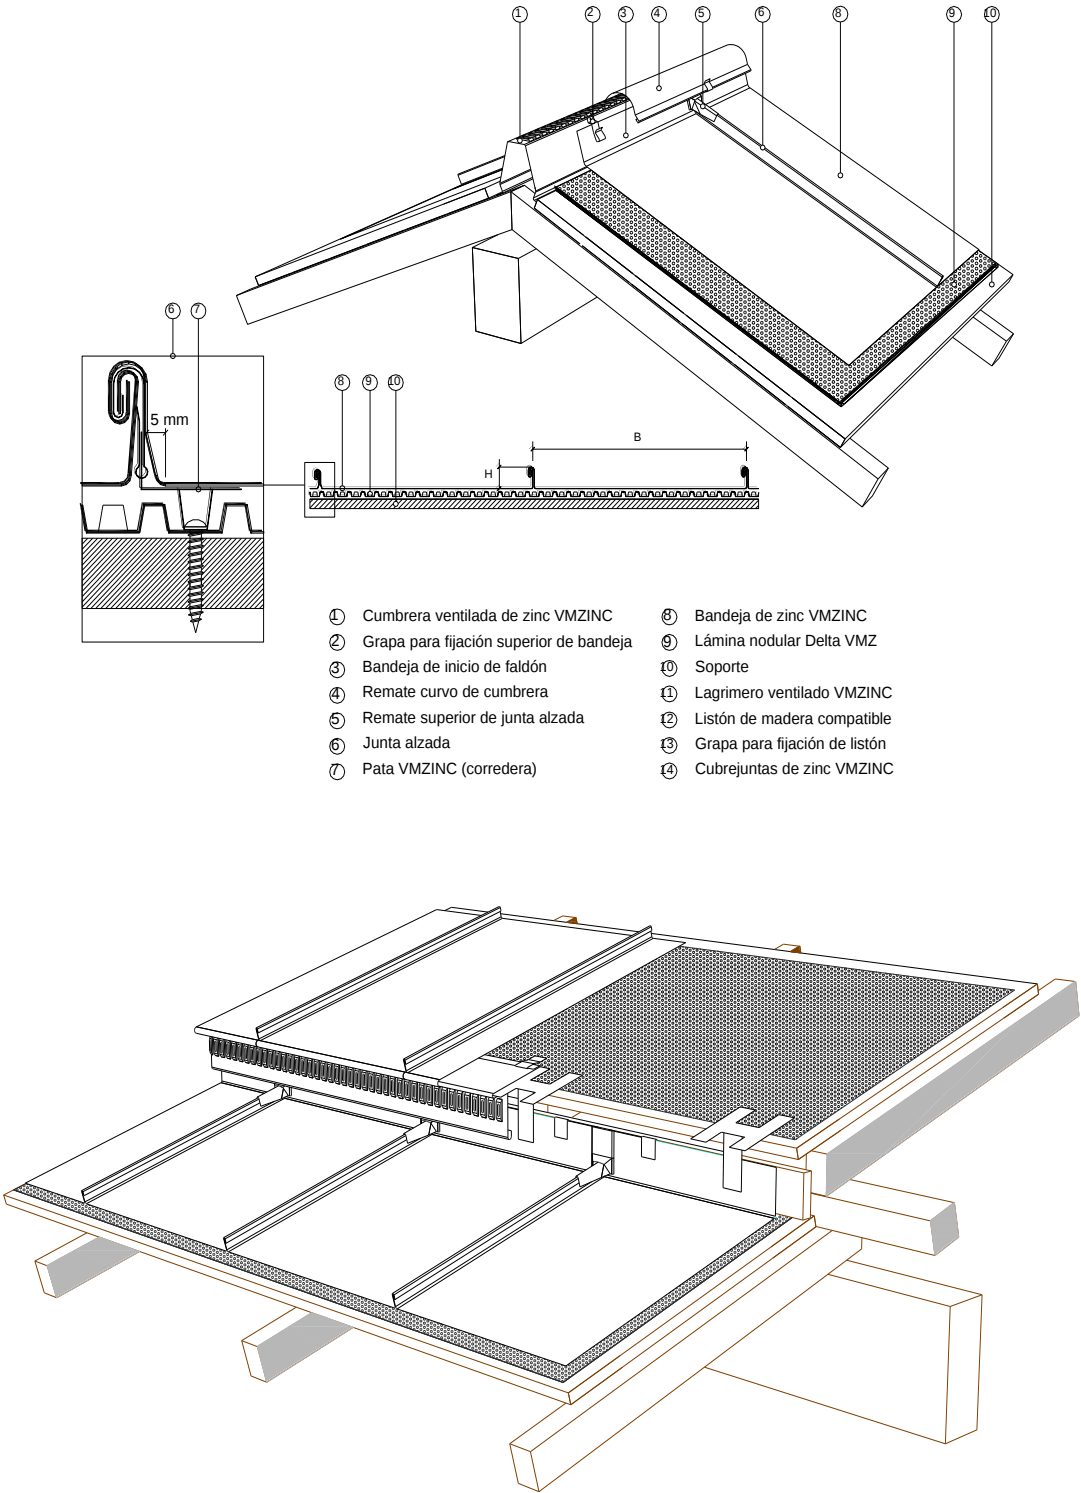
Ejemplo de faldón con junta alzada. Vistas generales y detalle.
